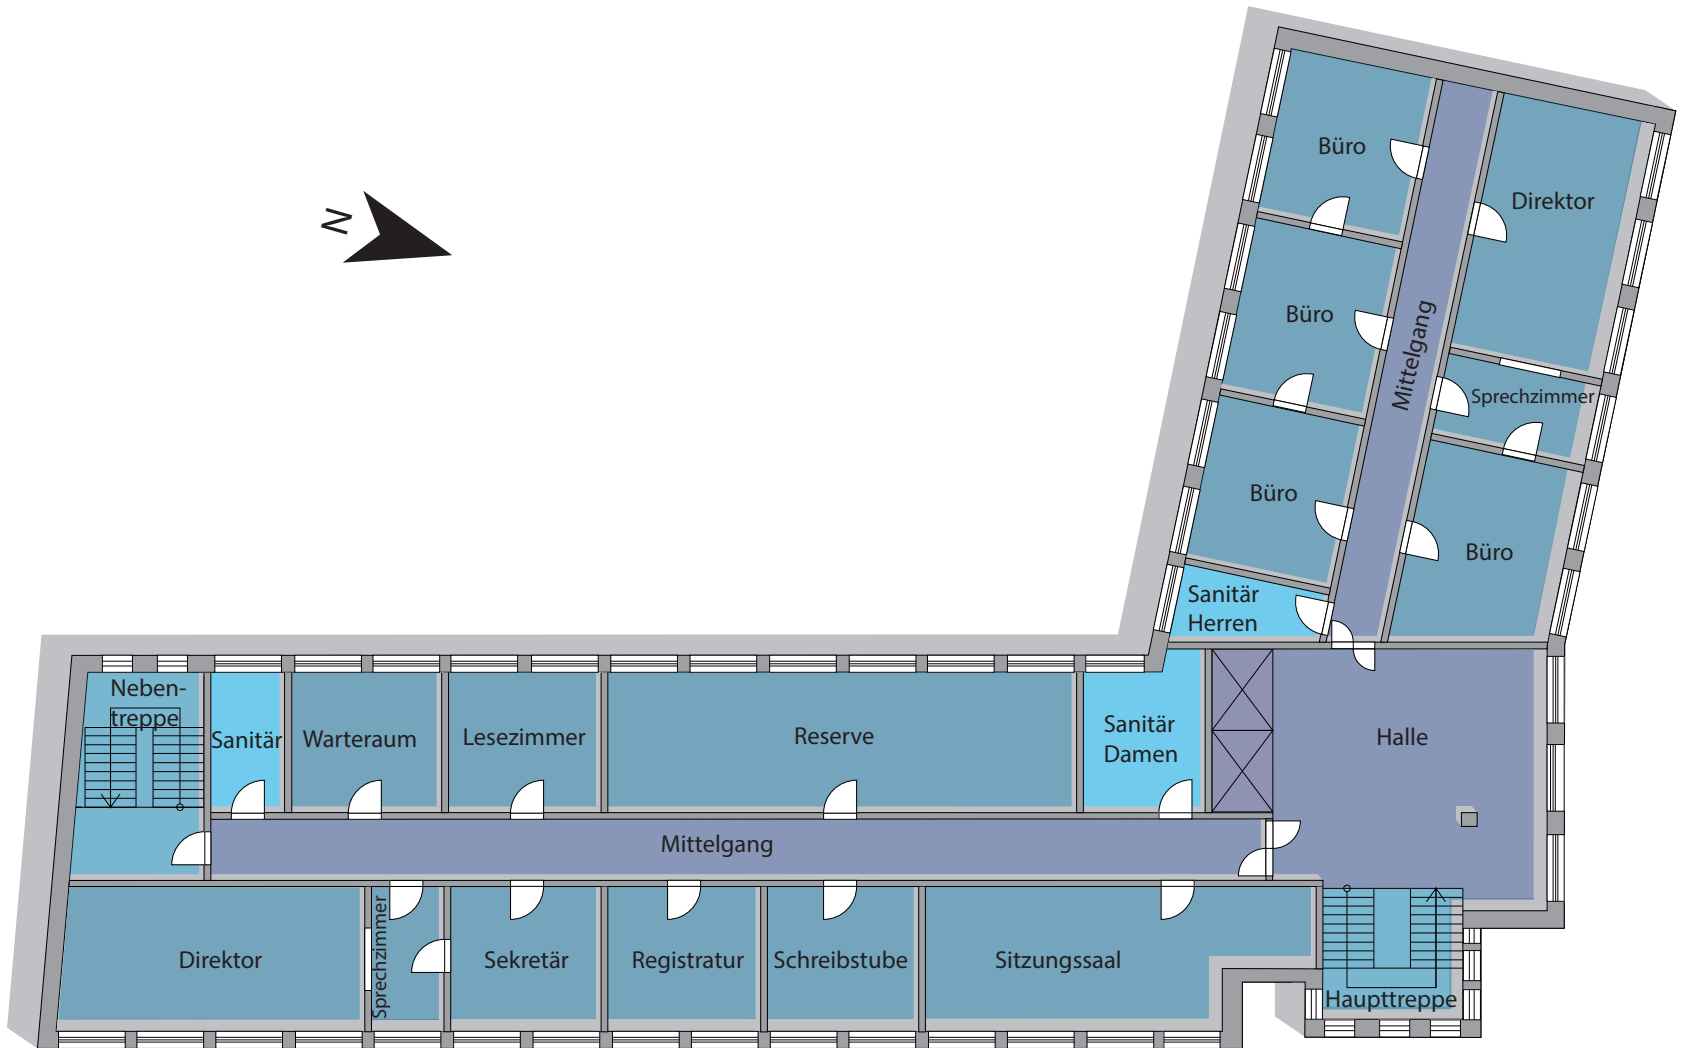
Grundriss des Erdgeschosses mit schematischer Zonierung der Nutzung
